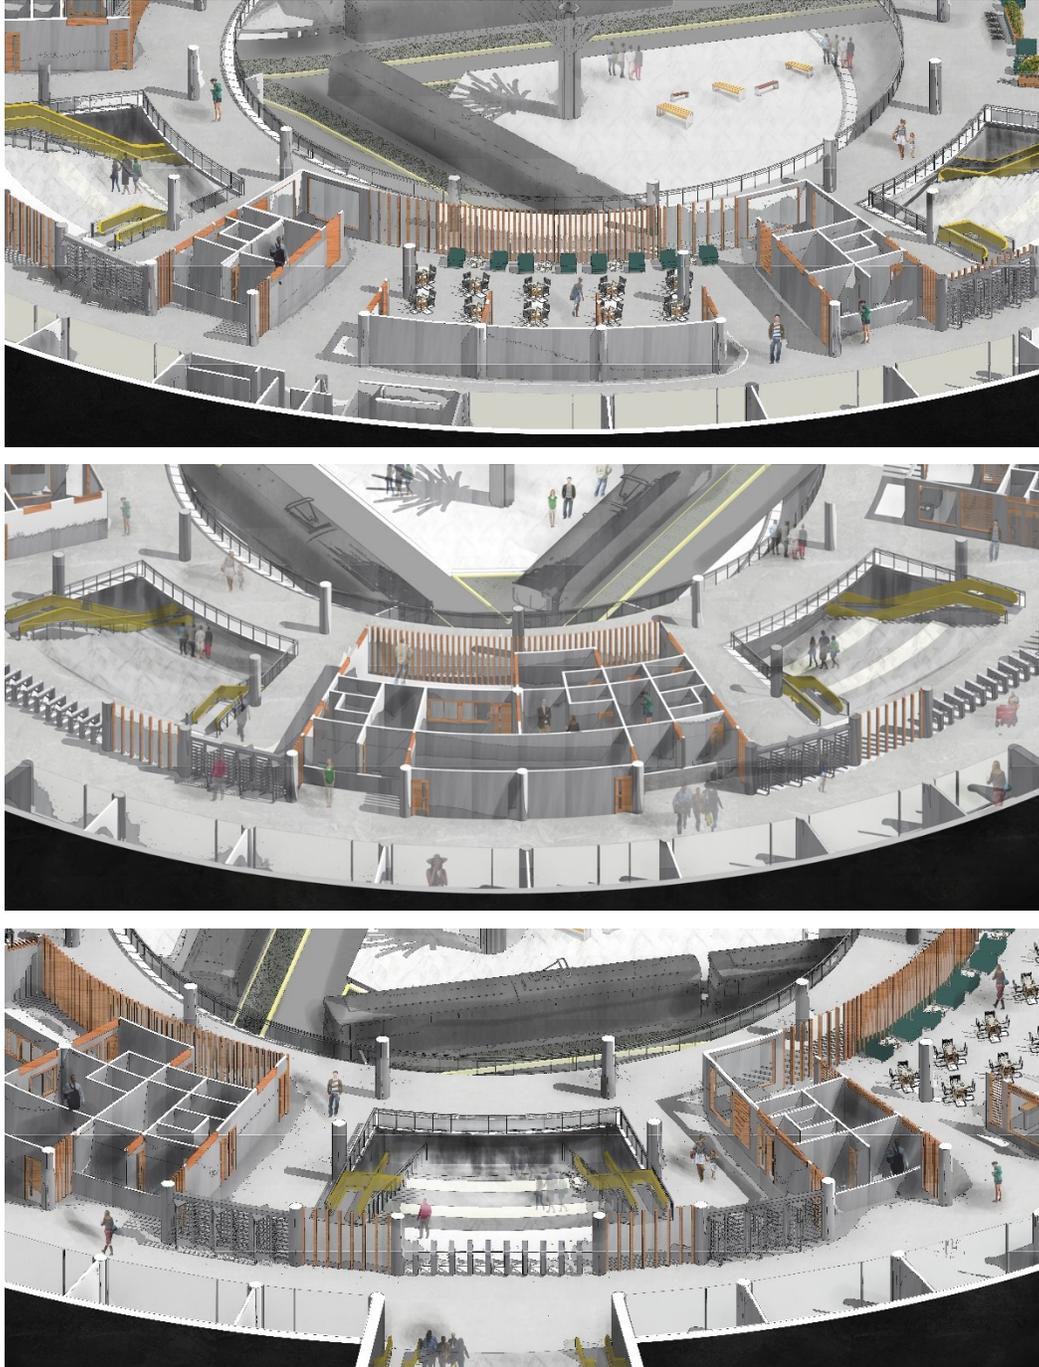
Renders Vista Espacial de Cafetería Externa
